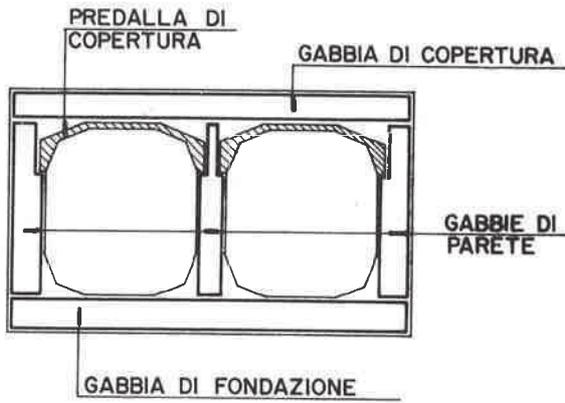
Tipologia degli elementi prefabbricati dei Canali
